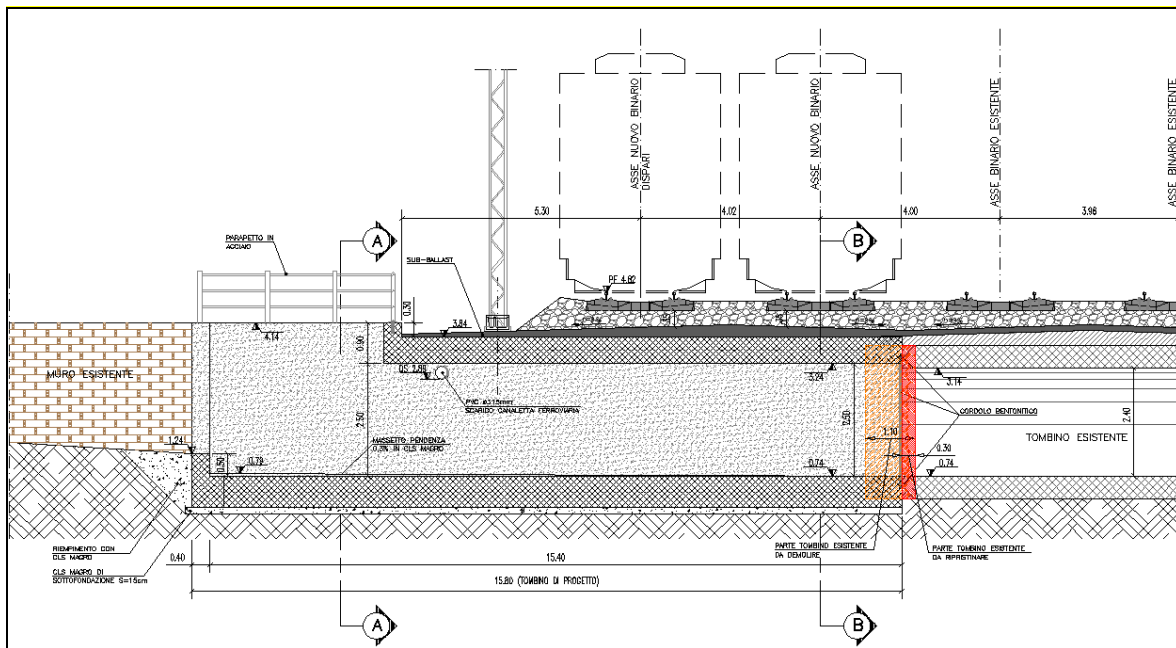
stralcio planimetrico attraversamento idraulico 4.00x2.50
